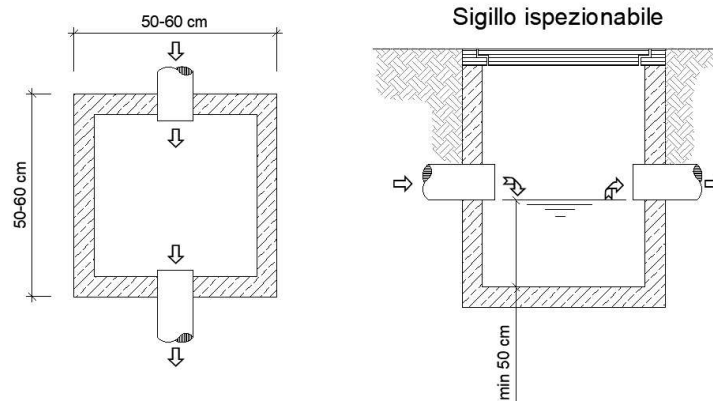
Schema pozzetto di sedimentazione e prelievo campioni
